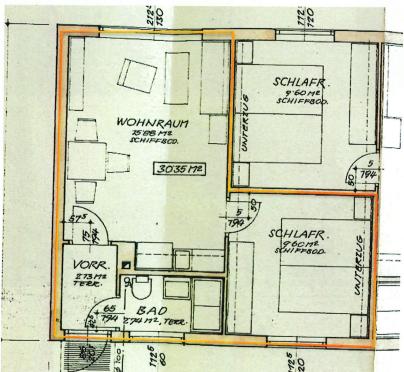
Grundriss Bestandsobjekt (Einreichplan 1958)
